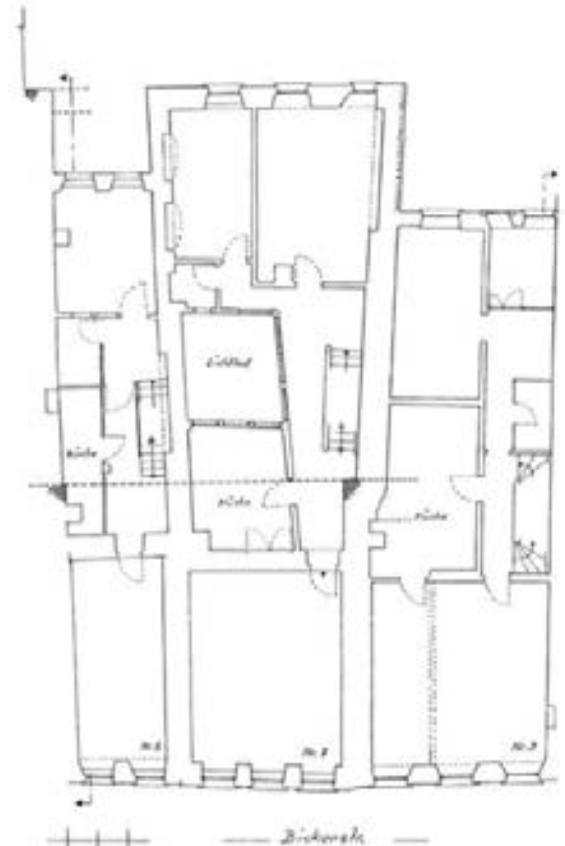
Villingen, Bickenstraße 5-9, Grundriss 2. OG.
